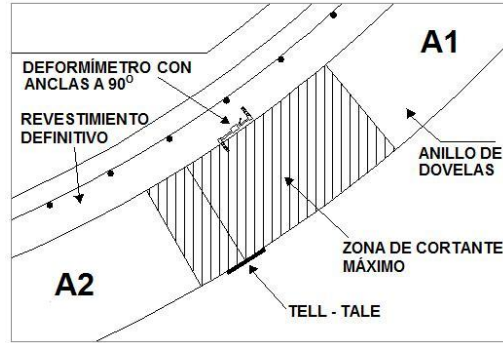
Detalle B: Instrumentación tipo en zonas de máximo cortante
